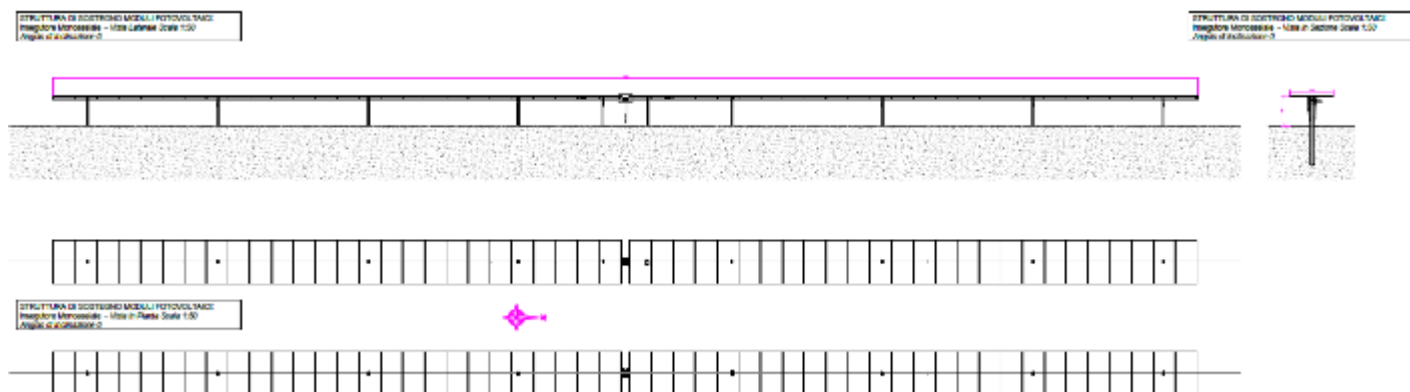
Disposizione dei tracker – vista in sezione e in pianta
